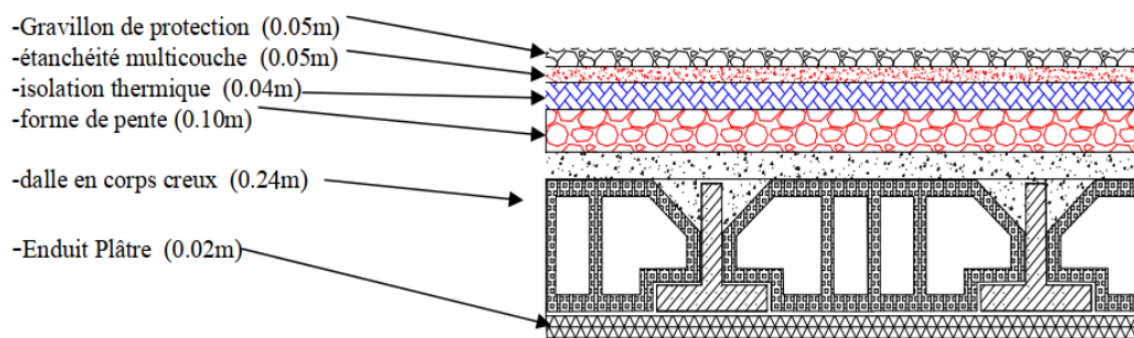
Schéma d'un plancher - terrasse inaccessible
